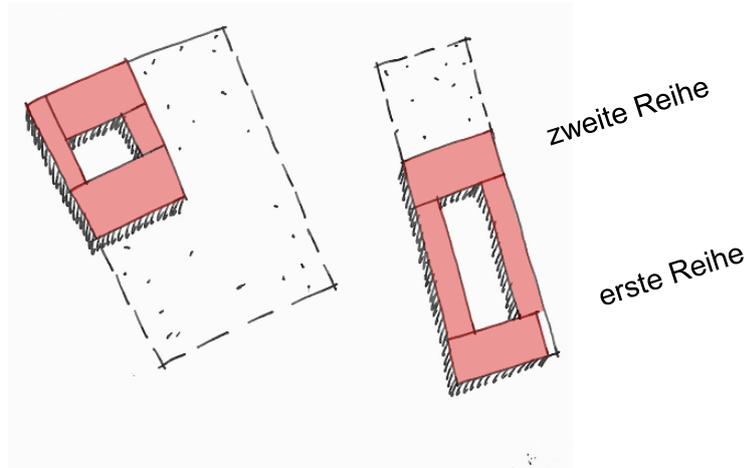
Haus-Hof-Bauweise entlang der Hauptstraße im östlichen Altort
